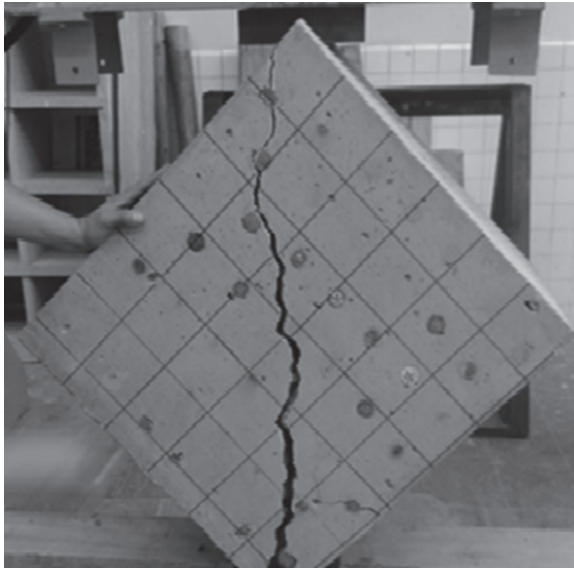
Ensayo a compresión axial de prismas de mampostería PET
